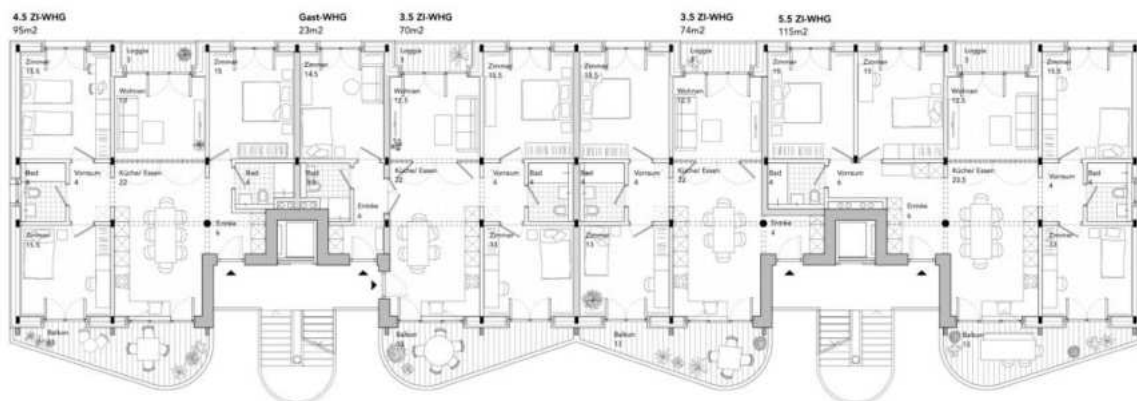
Grundriss Erdgeschoss mit Umgebung, Papillon
